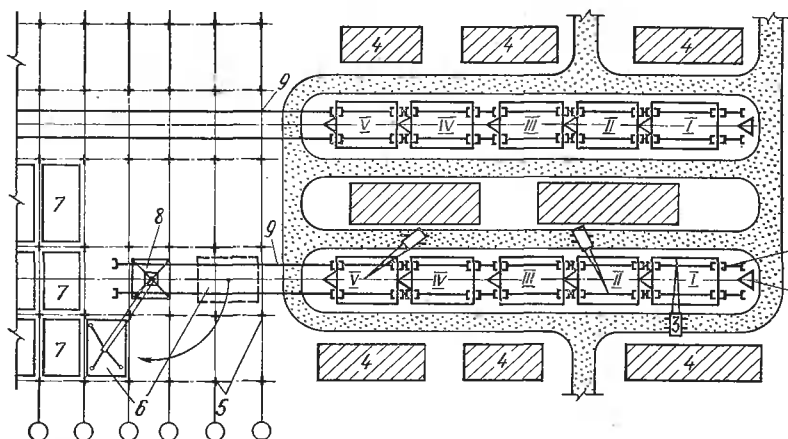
Фрагмент стройгенплана монтажных работ методом конвейерной сборки:
